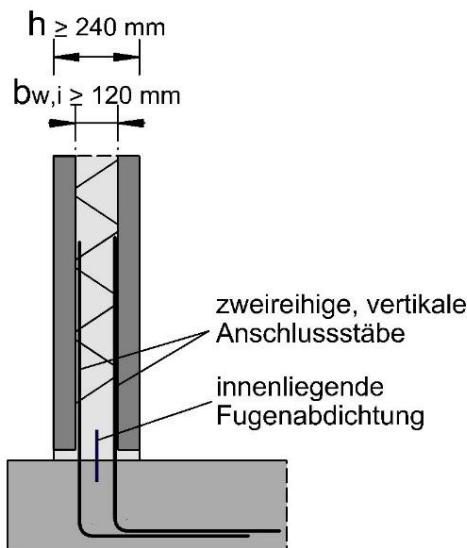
Elementwand mit Wanddicke von 240 mm und innenliegender Fugenabdichtung mit zweireihiger Anschlussbewehrung aus einzelnen vertikalen Bewehrungsstäben
